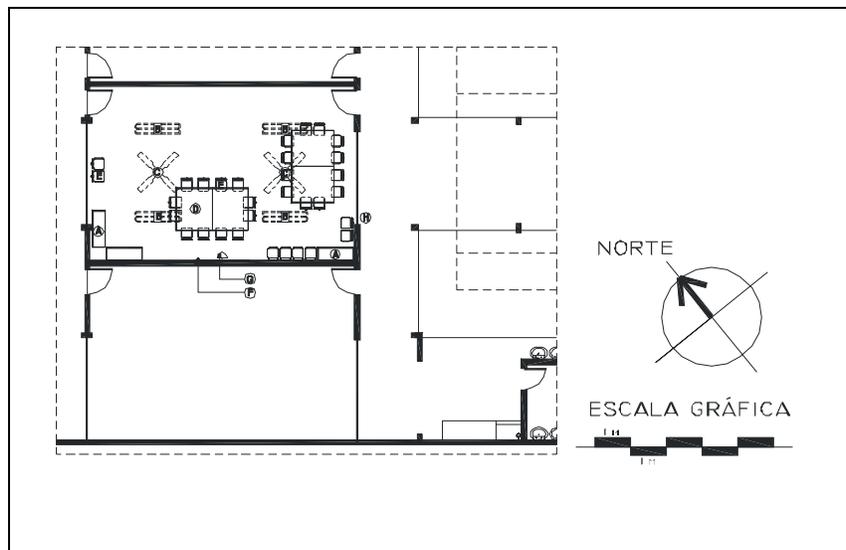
Planta Baixa da sala de aula/atividades do Maternal 2
